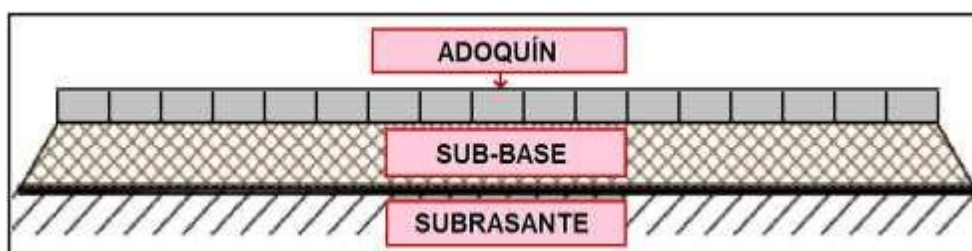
Sección Transversal del Pavimento Articulado o mixto.
